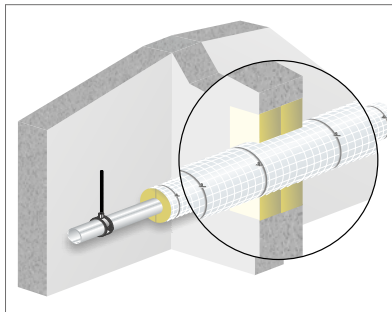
Dämmung durch Weichschott hindurchgeführt – Wand
